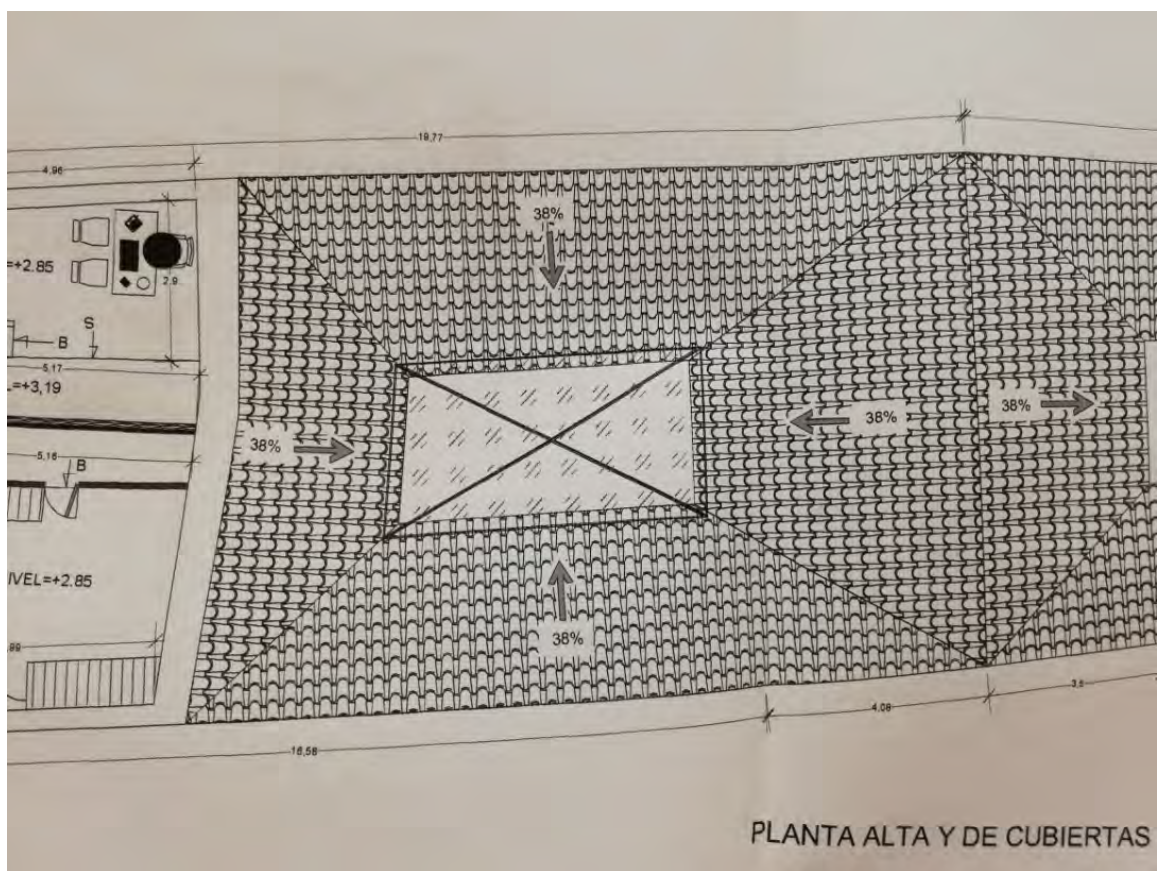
Planta alta y cubiertas. Fuente: DAHP, 2010. Elaboración: propia
